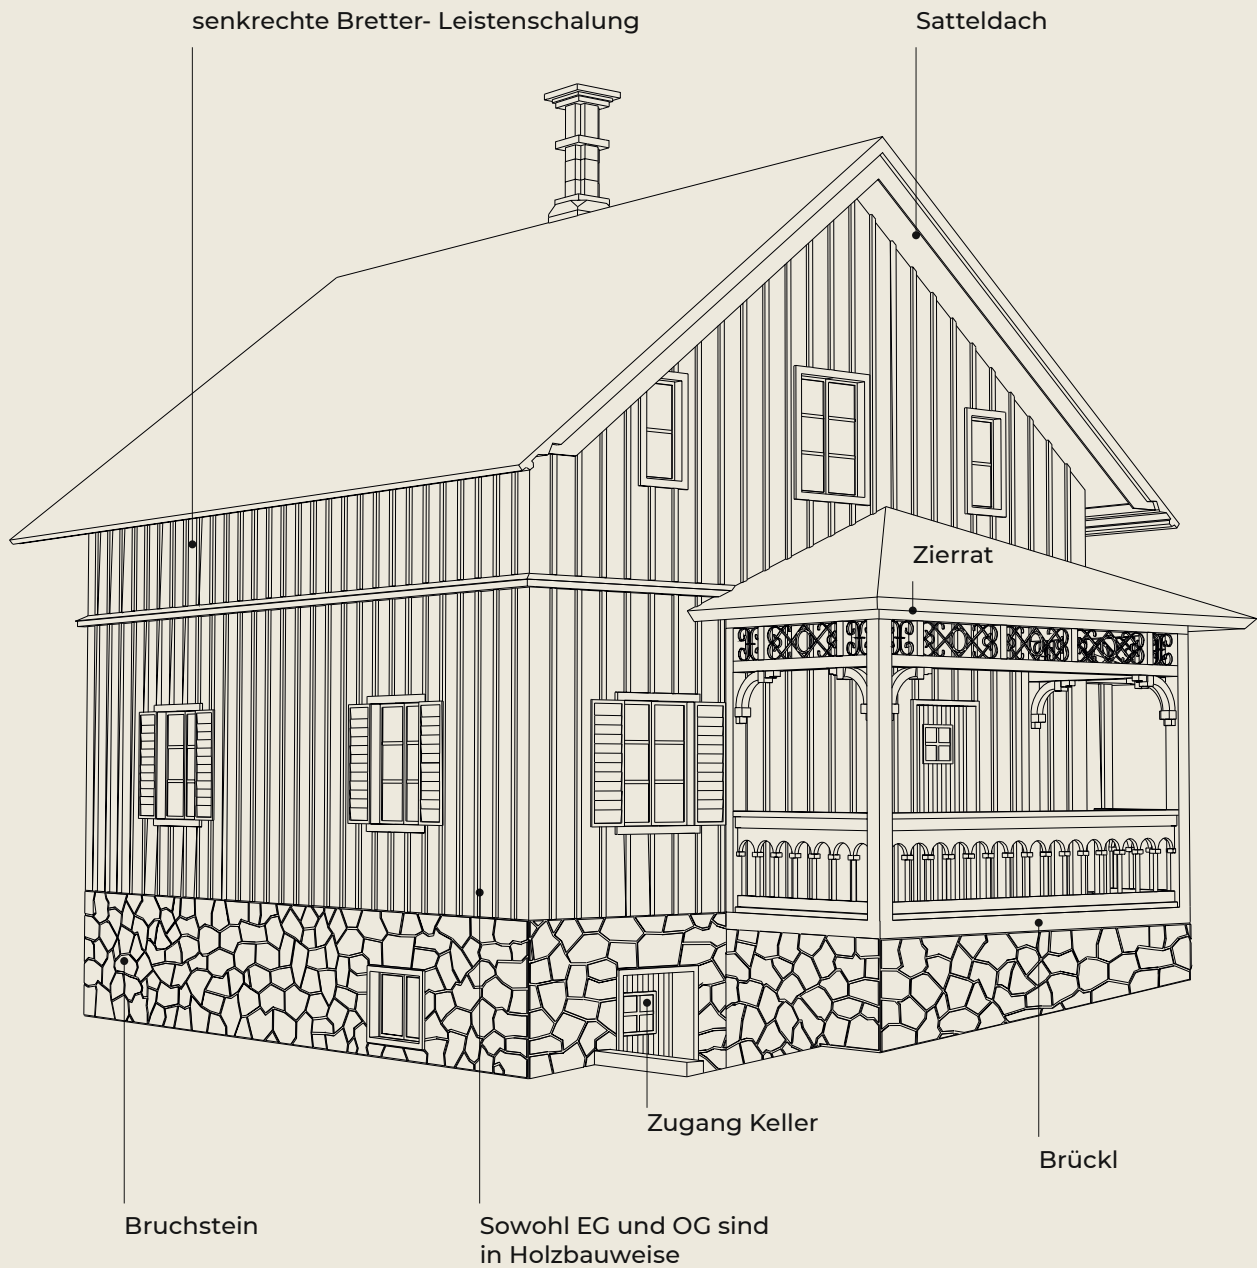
Wohnhaus nach Stöckl-Plan., Axonometrie mit Details.
